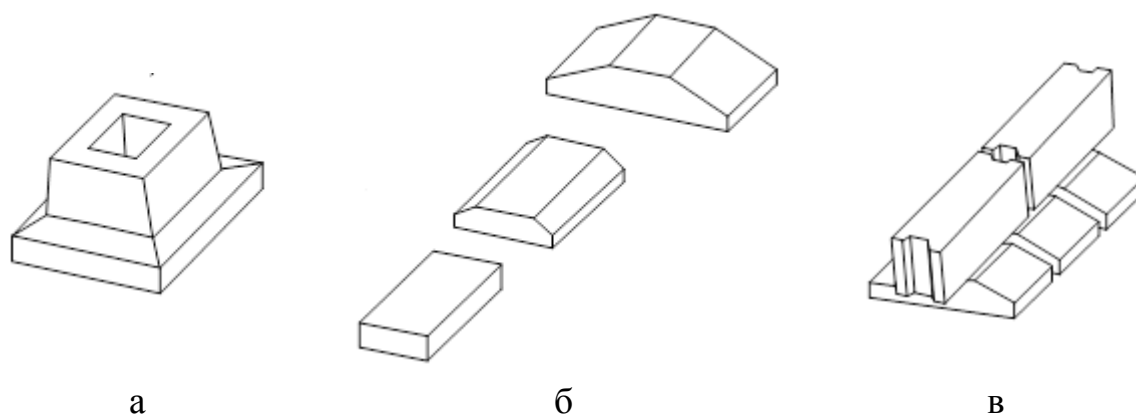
Фундаменты и стены подвалов: а – фундамент под колонны; б – блоки ленточного фундамента стен; в – блоки стен подвалов
